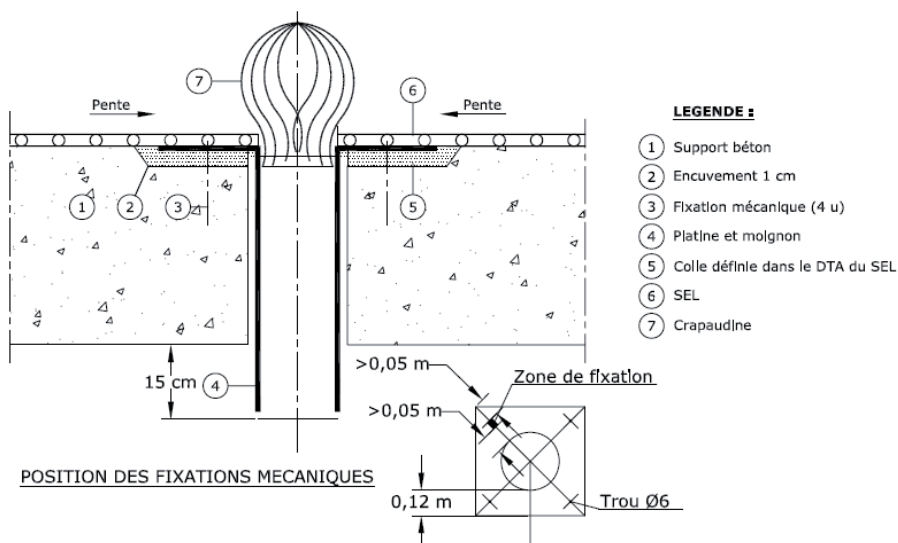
Exemple de traitement d'une évacuation d'eau pluviale avec platine
